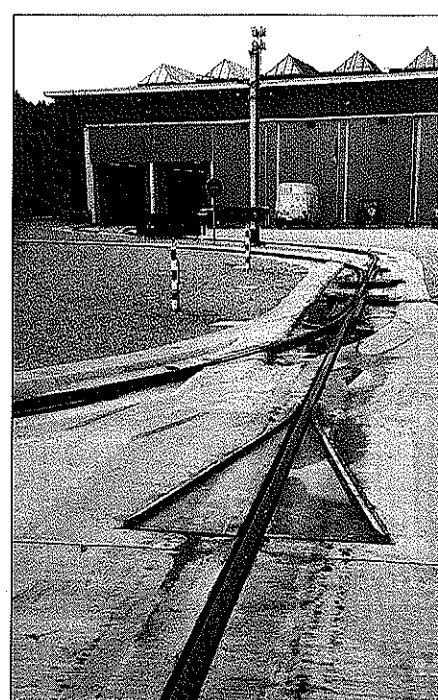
(links): GLT-System (Guided-Light-Transit) Strecke Jemelle – Rochefort, 600-V-Oberleitungsbetrieb mit Mittelschiene. Hier werden Beton-Fahrbahnen verwendet. Eine Alternative sind Fahrbahnen aus Stahl, direkt auf Schwellen befestigt. Die Leitplancken dienen der Sicherheit
